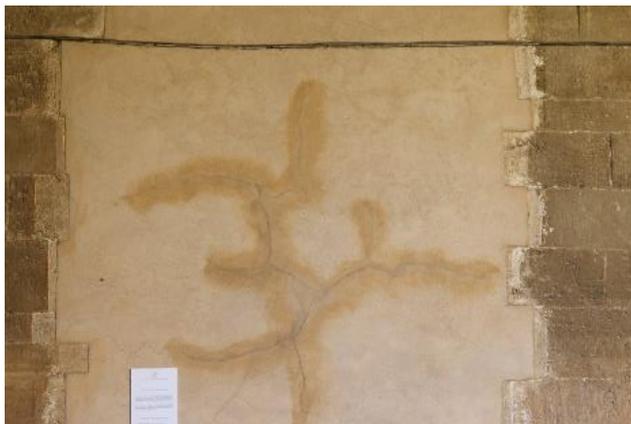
Viga flectada de la fachada norte del claustro.
